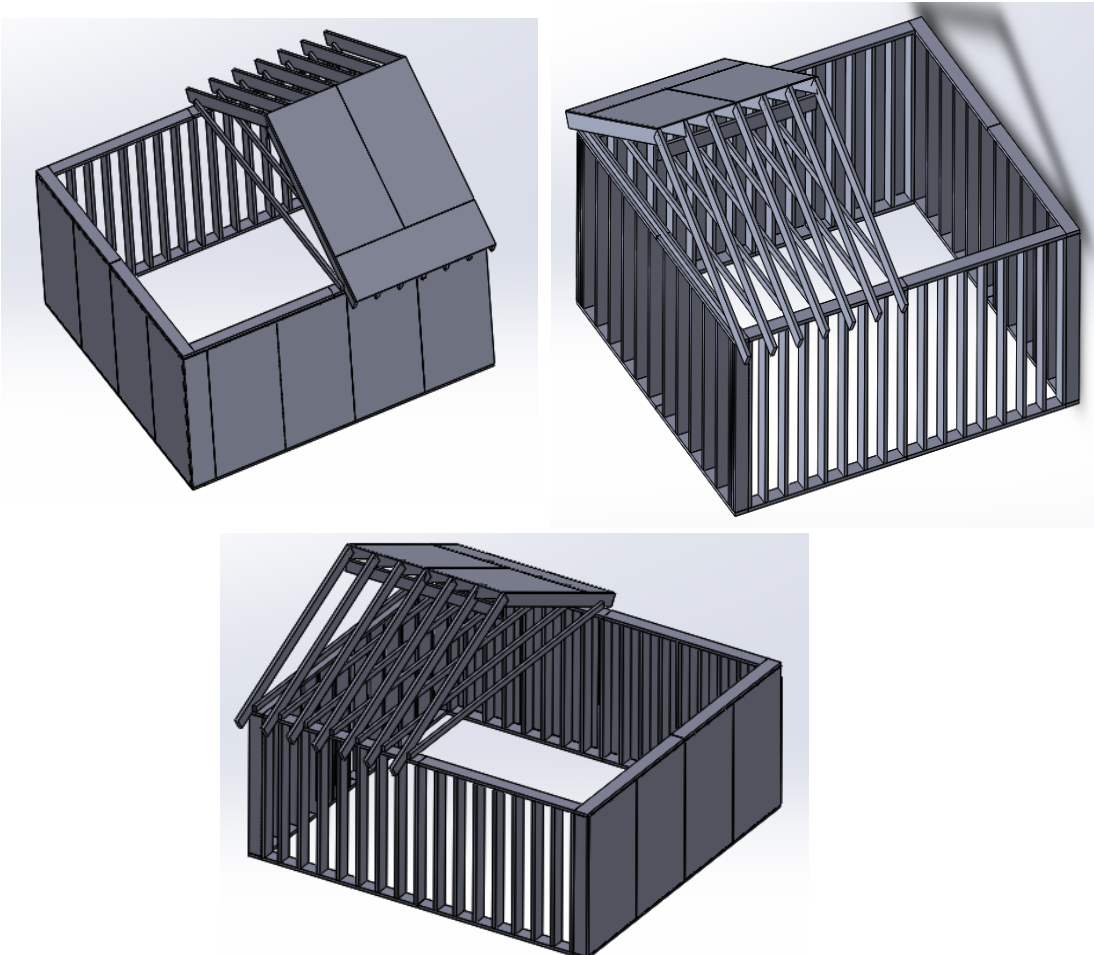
Modelo de construcción tipo americano usando solo barrotes de 2"x4" y paneles estructurales de 4x8 pies.
